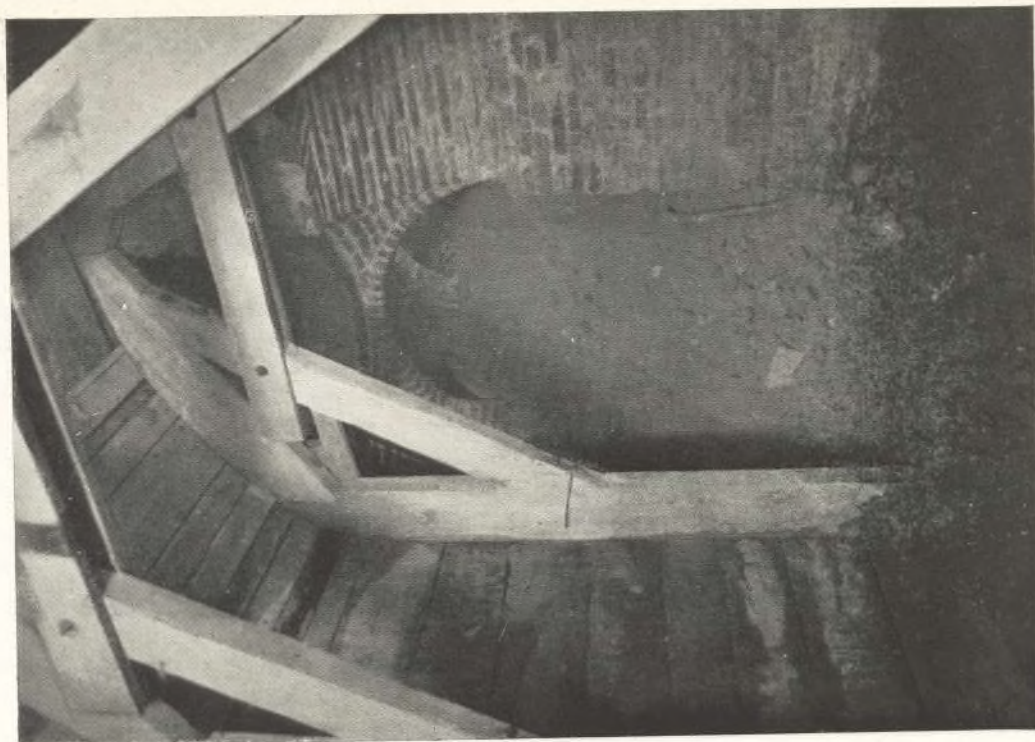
Galería de la calle Mayor. Pozo número 8. Frente hacia Capitanía.
